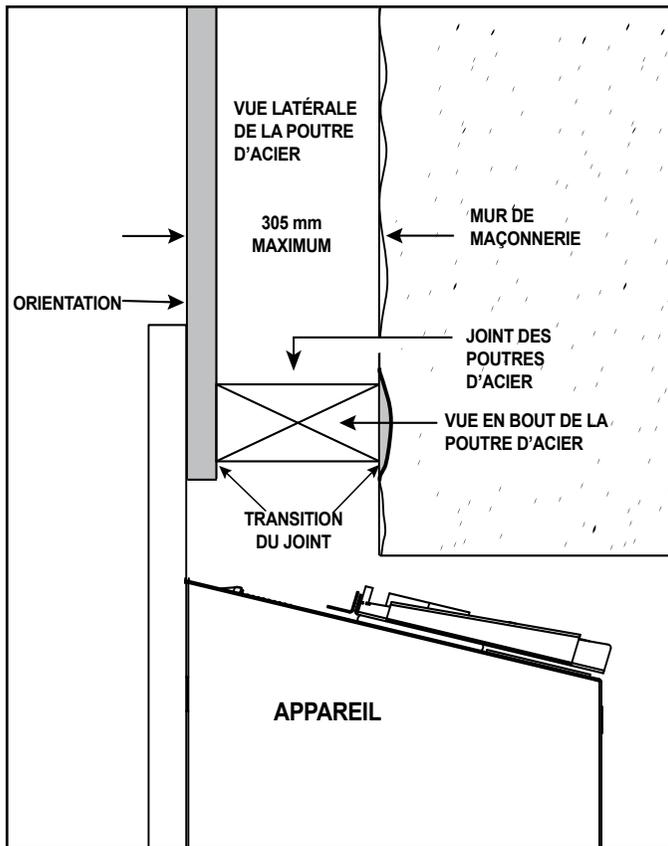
Détails sur l'étanchéité de transition pour les extensions murales (vue latérale)
